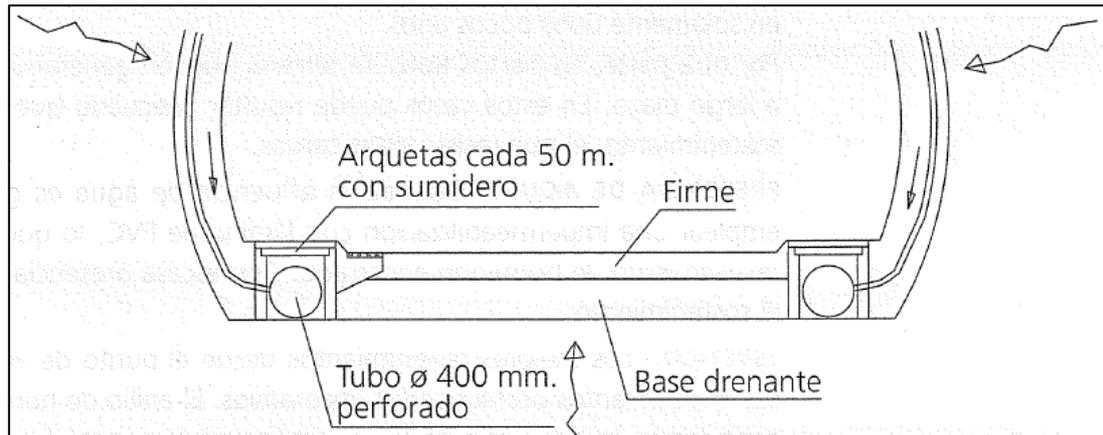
Esquema de drenaje longitudinal típico. Todo manual de túneles (Carlos Lopez Jimeno y otros).
